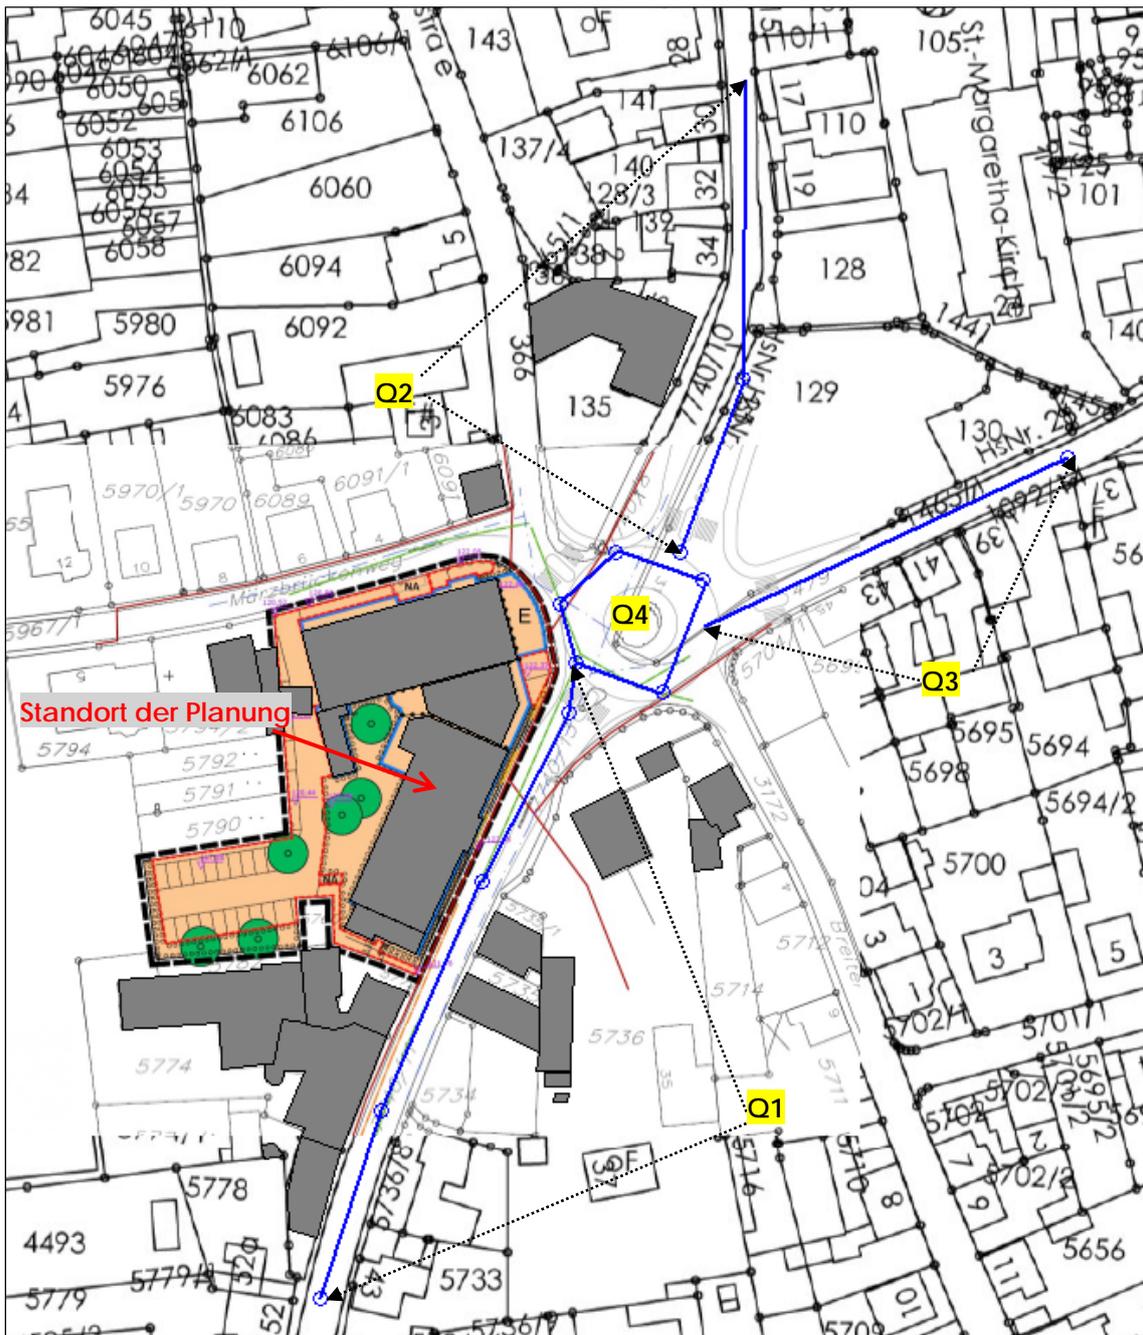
Lageplan mit Darstellung und Bezeichnung der betrachteten öffentlichen Straßen
